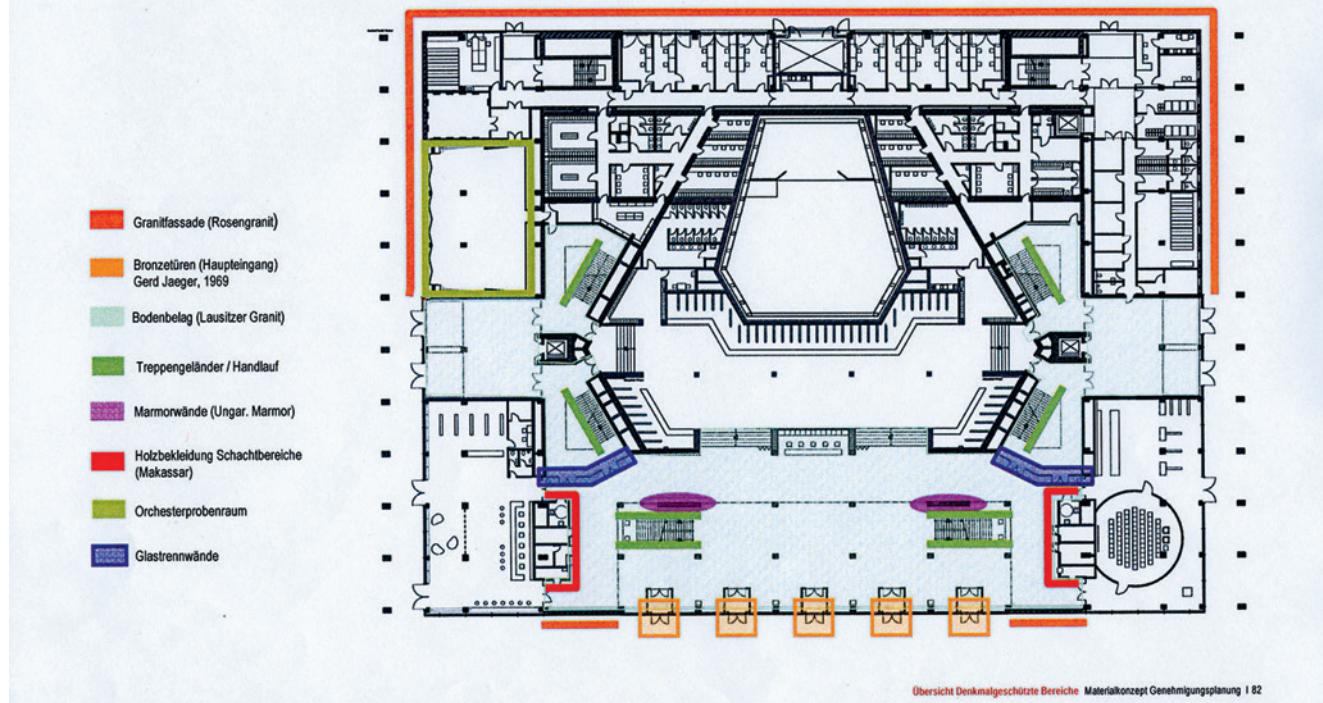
Kulturpalast Dresden, Grundriss Erdgeschoss mit Markierung denkmalrelevanter Bereiche, Genehmigungsplanung, 2011 (© gmp Architekten)
